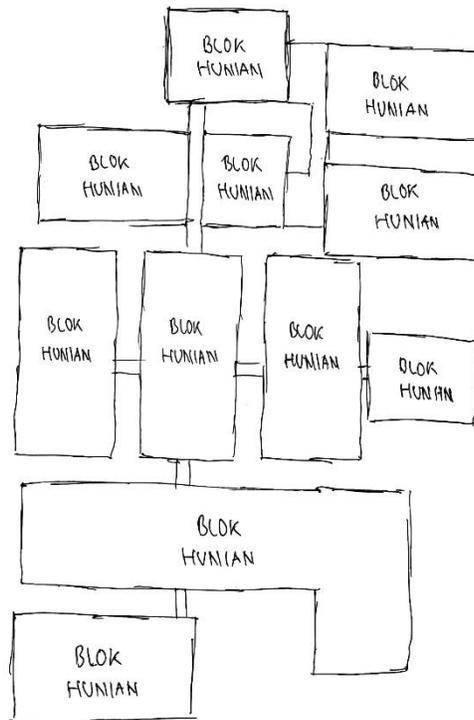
27 Rancangan Layout Lantai Tipikal (1 s/d 6)
